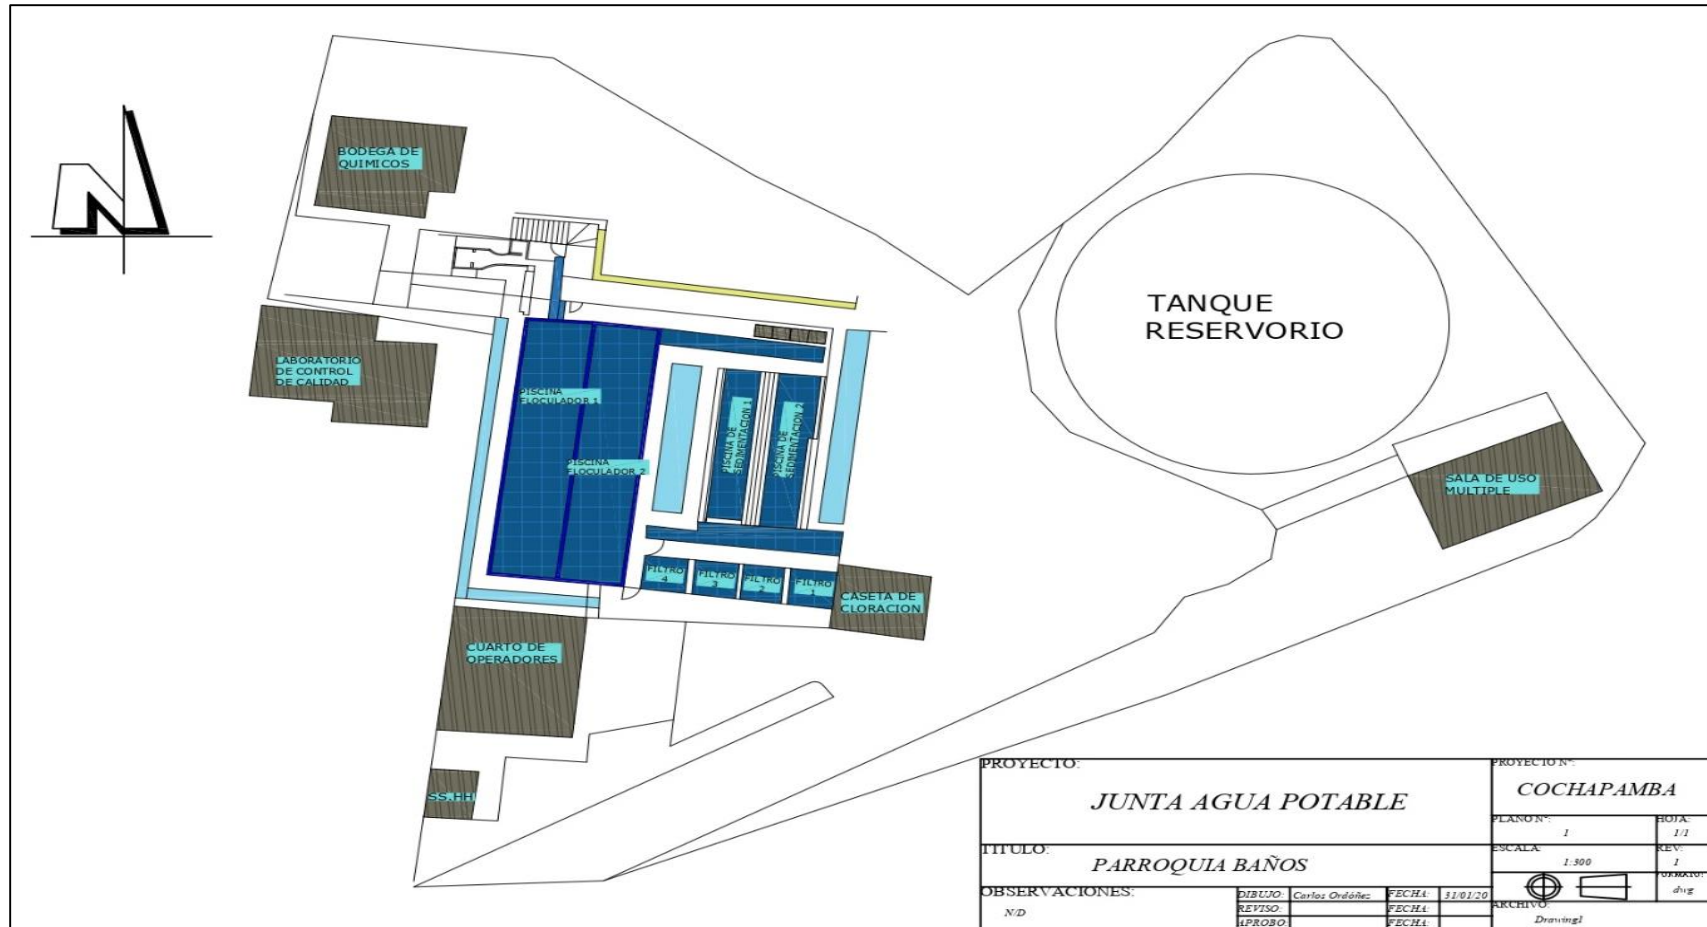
Plano de Planta de Tratamiento de Cochapamba
